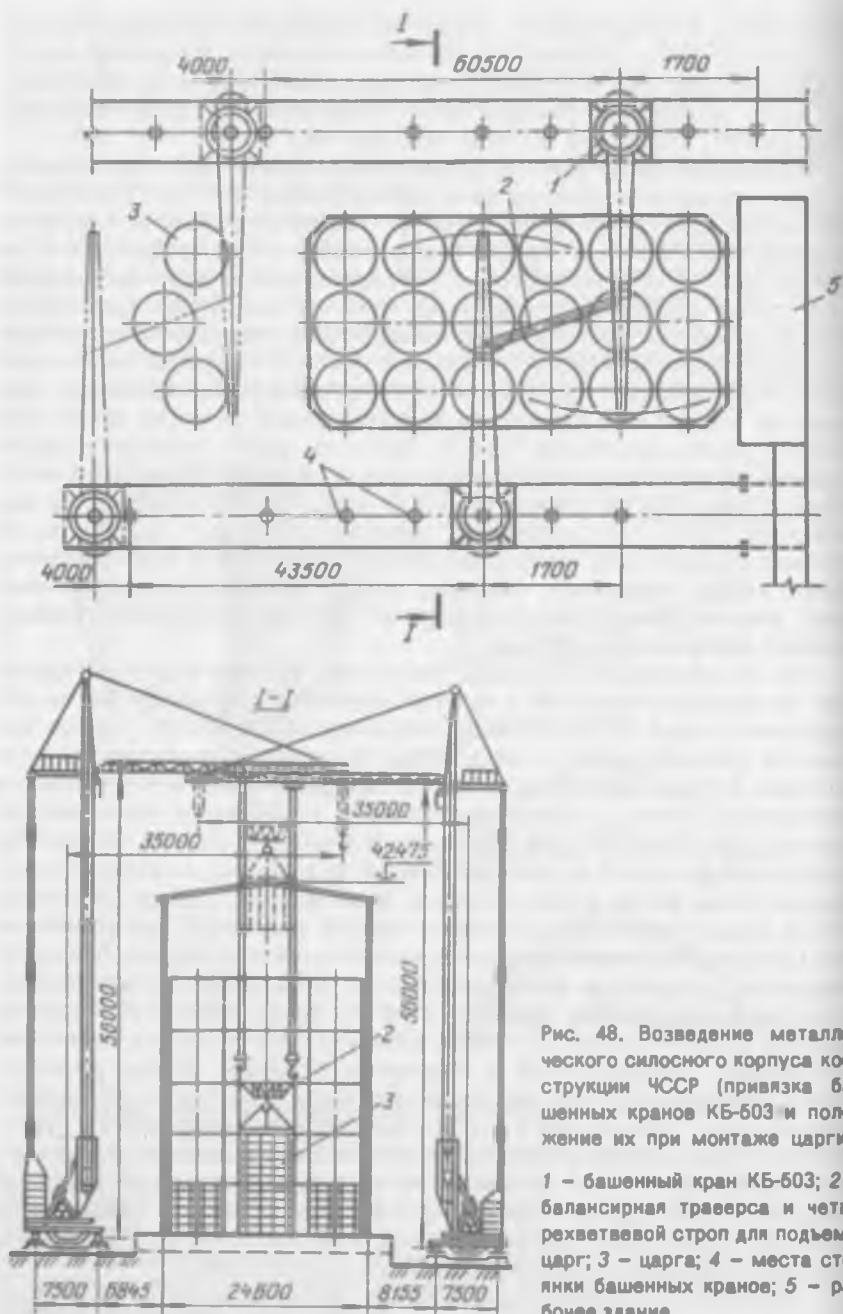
Возведение металлического силосного корпуса конструкции ЧССР (привязка башенных кранов КБ-503 и положение их при монтаже царги):
